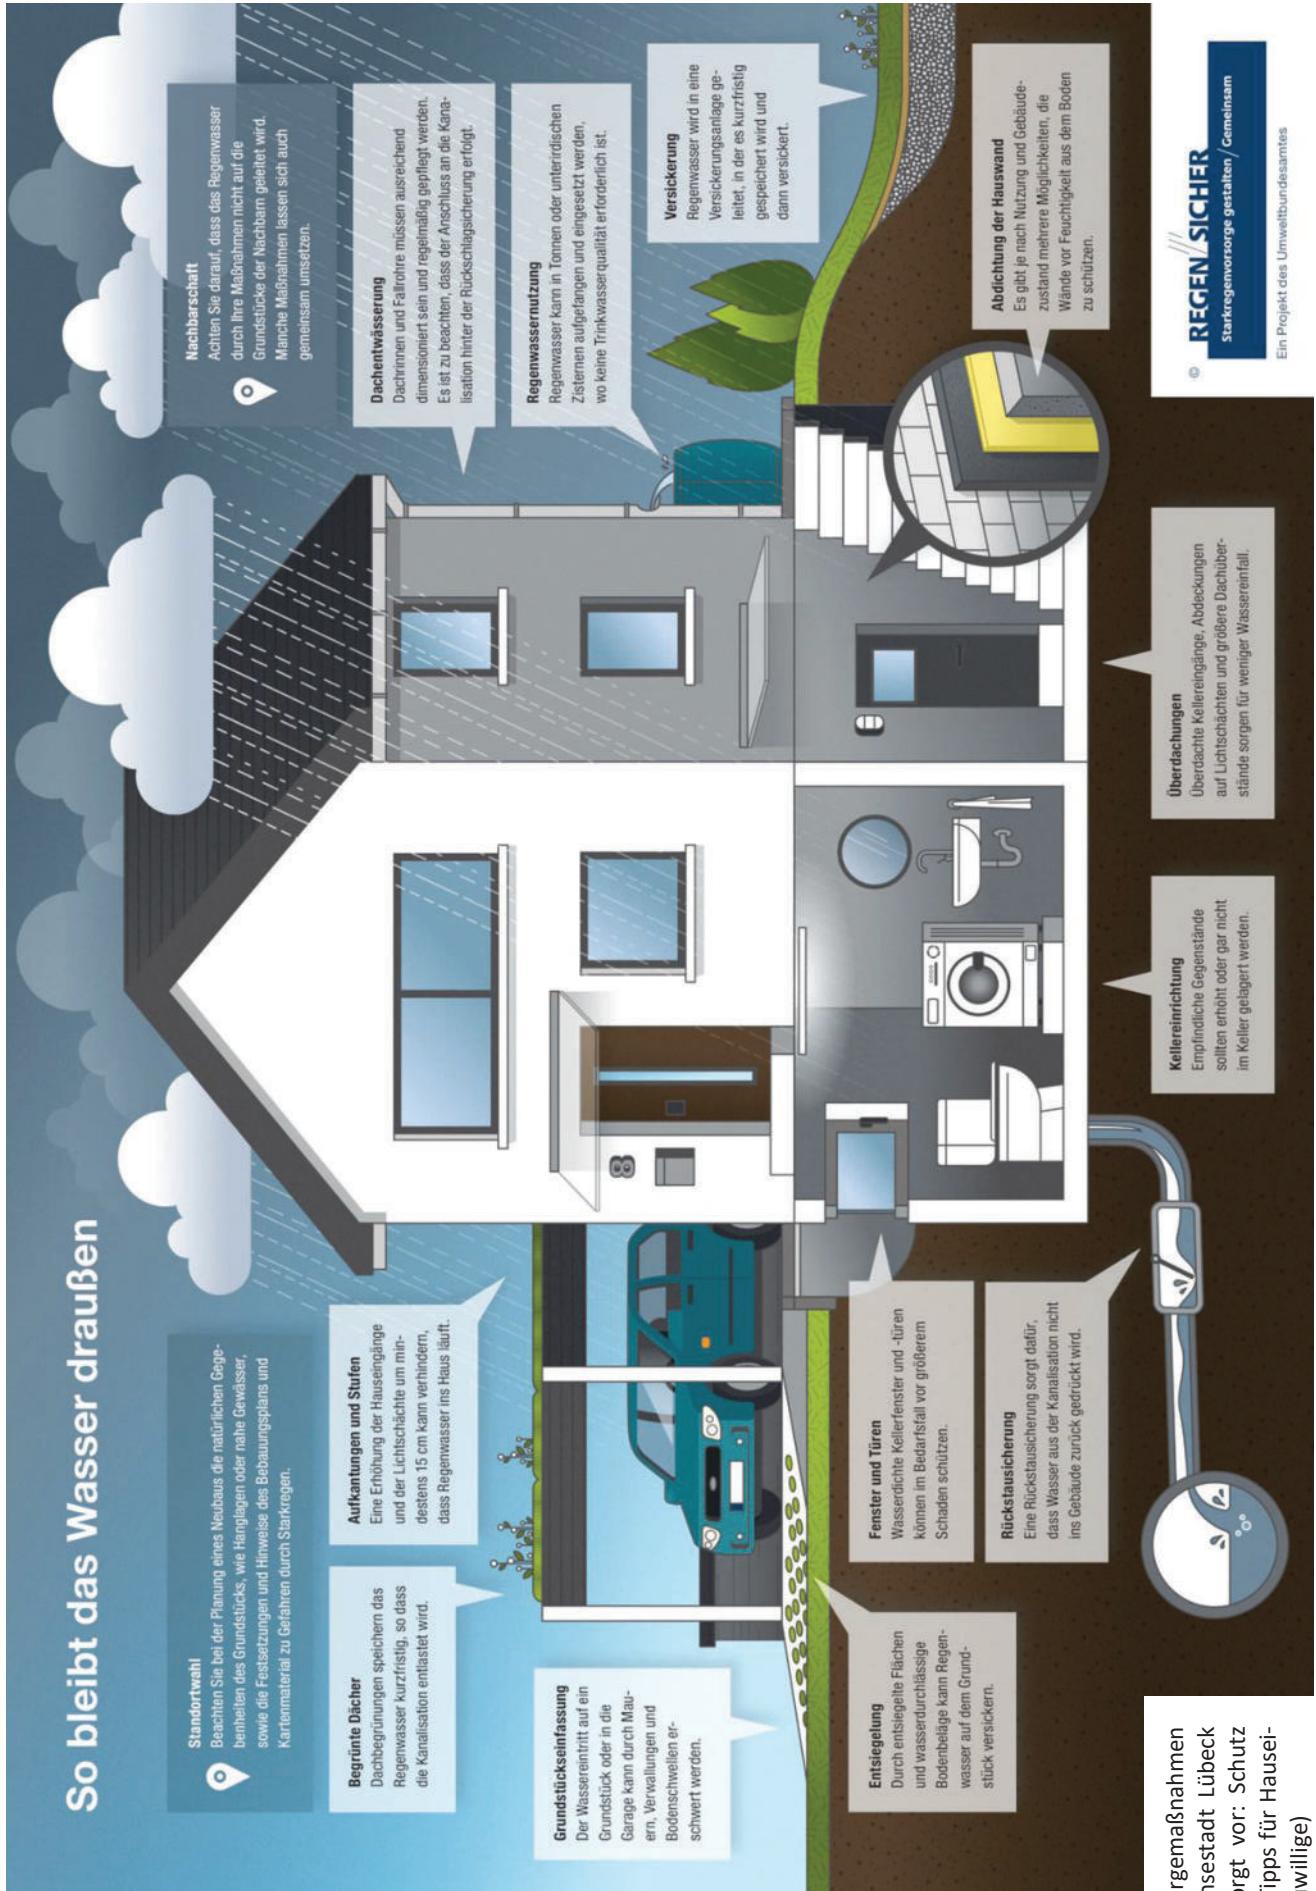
Bauvorsorgemaßnahmen am Gebäude (Hansestadt Lübeck (2018); Lübeck sorgt vor: Schutz vor Starkregen – Tipps für Hausten und Bauwillige)
